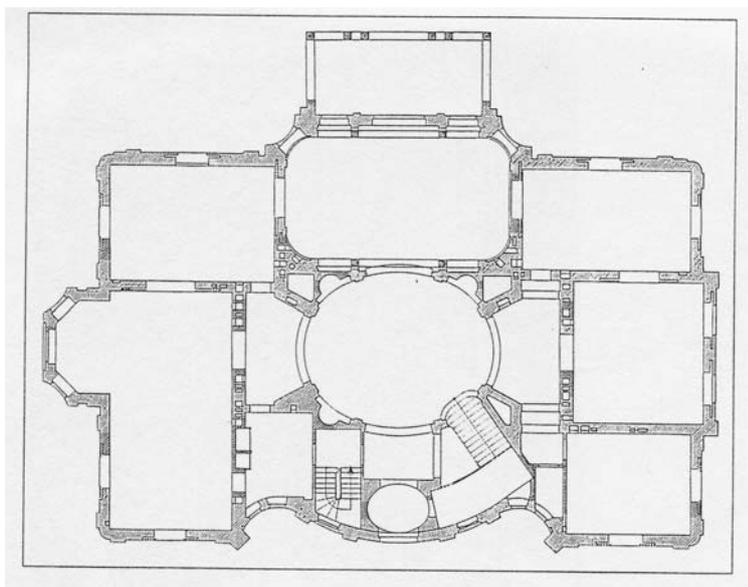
Villa Seyd, Grundriss Erdgeschoss
